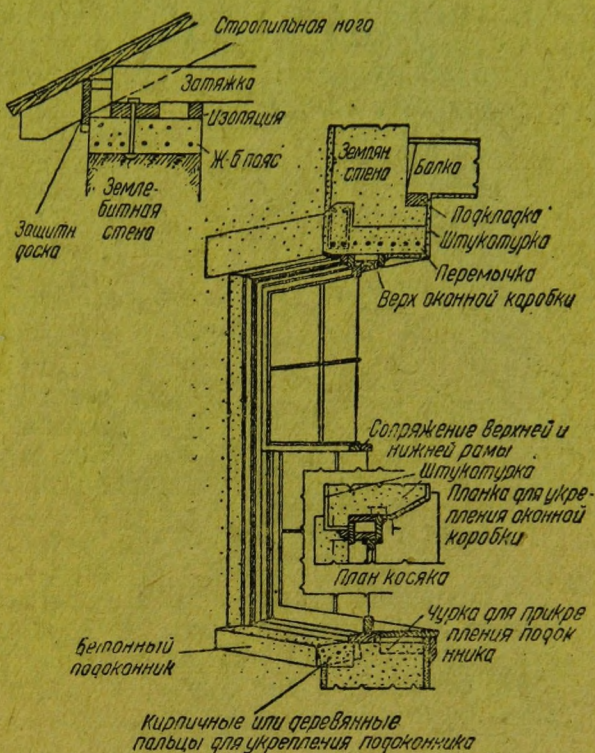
Американский способ перекрытия проемов и верха стен жел.-бетонными поясами
